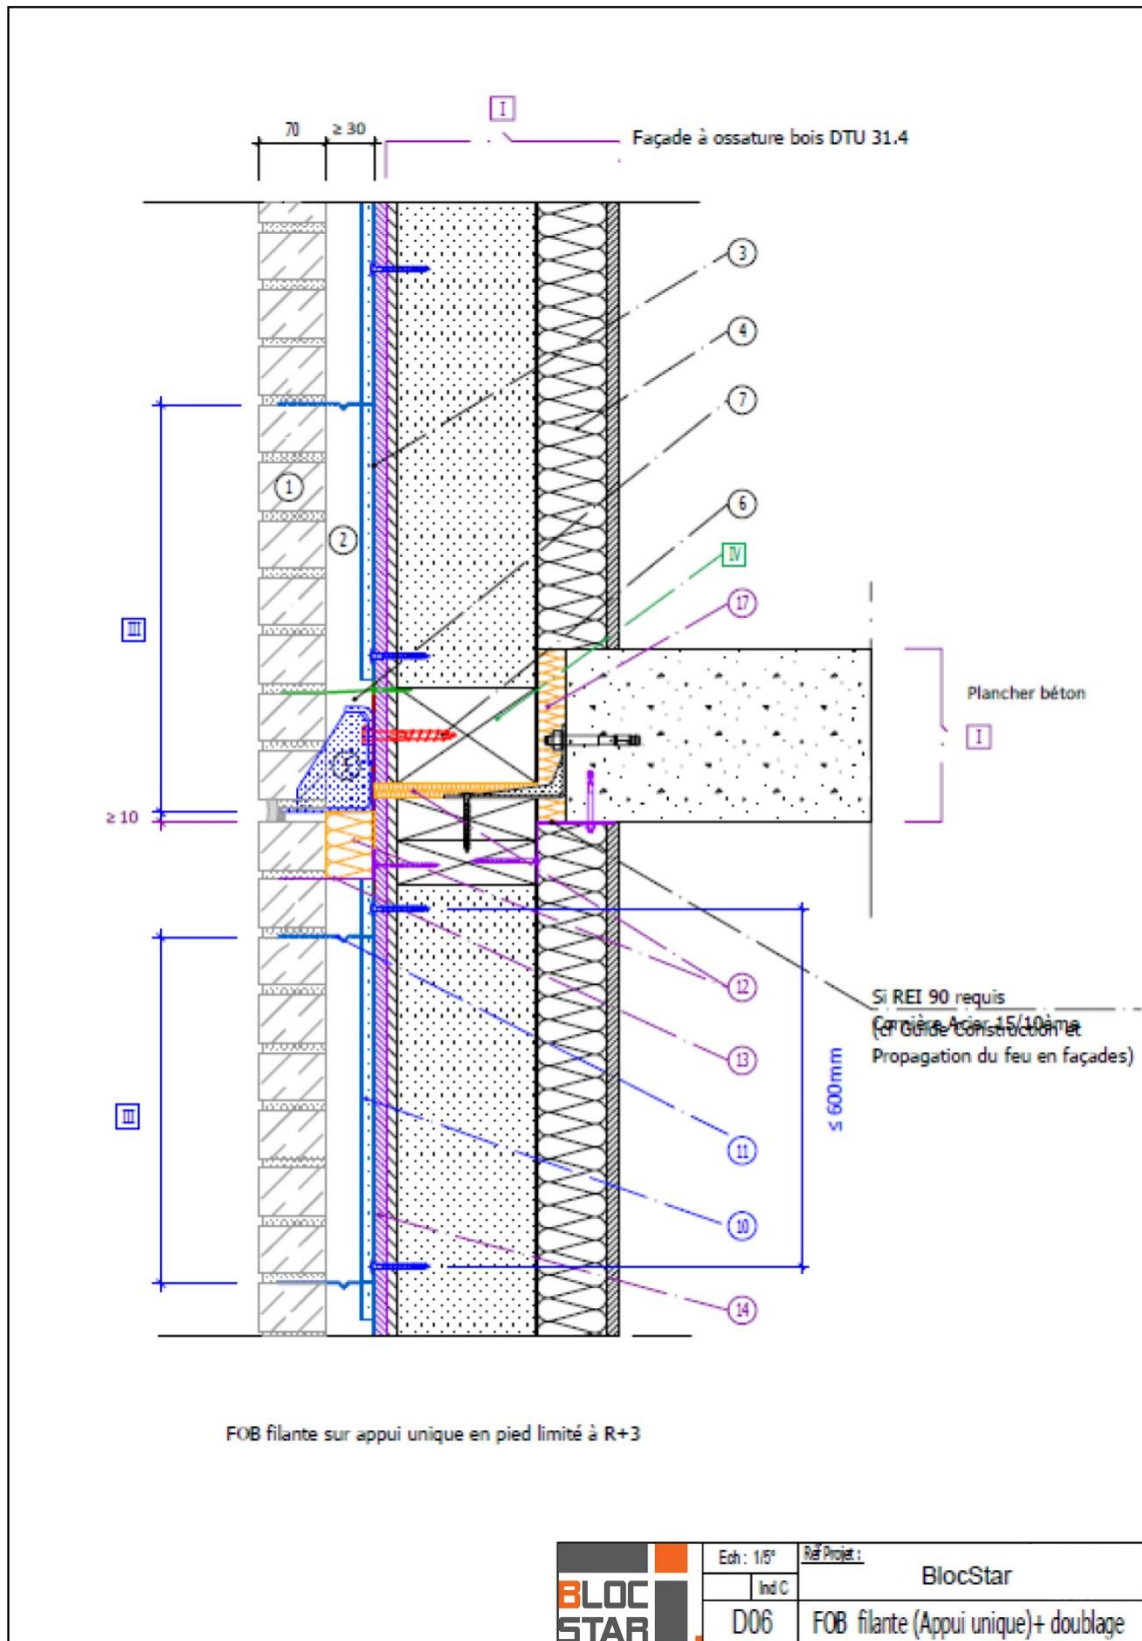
Etanchéité à la jonction avec un nez-de-dalle en béton
